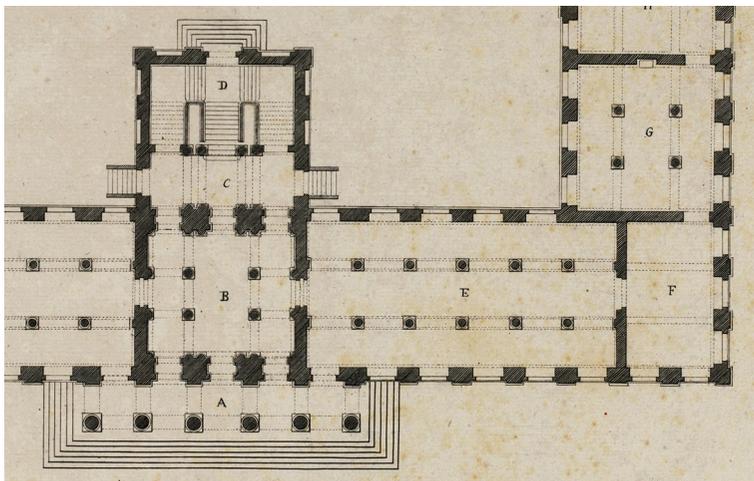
John. Karl Müller/Simon Louis Du Ry, [Grundriss des Museum Fridericianum](#), 1784. Detail des Erdgeschosses mit »Salle tetrastile« (G).
